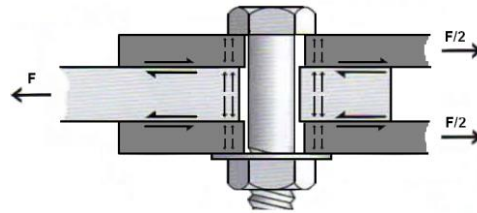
Conexión tipo deslizamiento crítico
